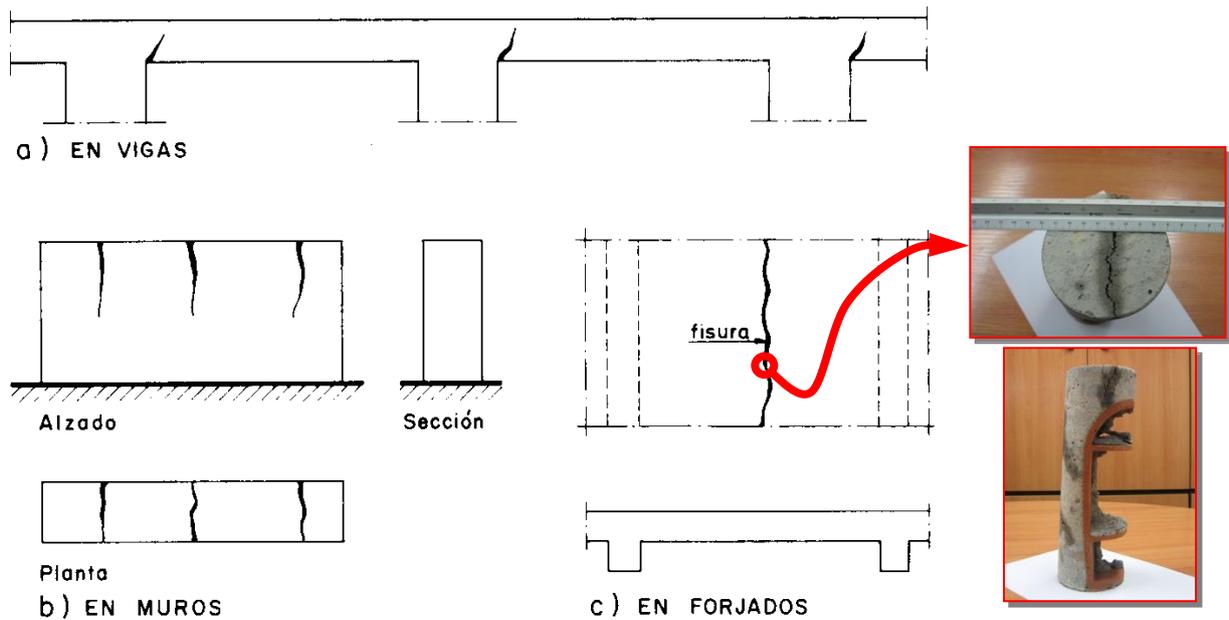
Fisuras de retracción en distintos elementos de hormigón
